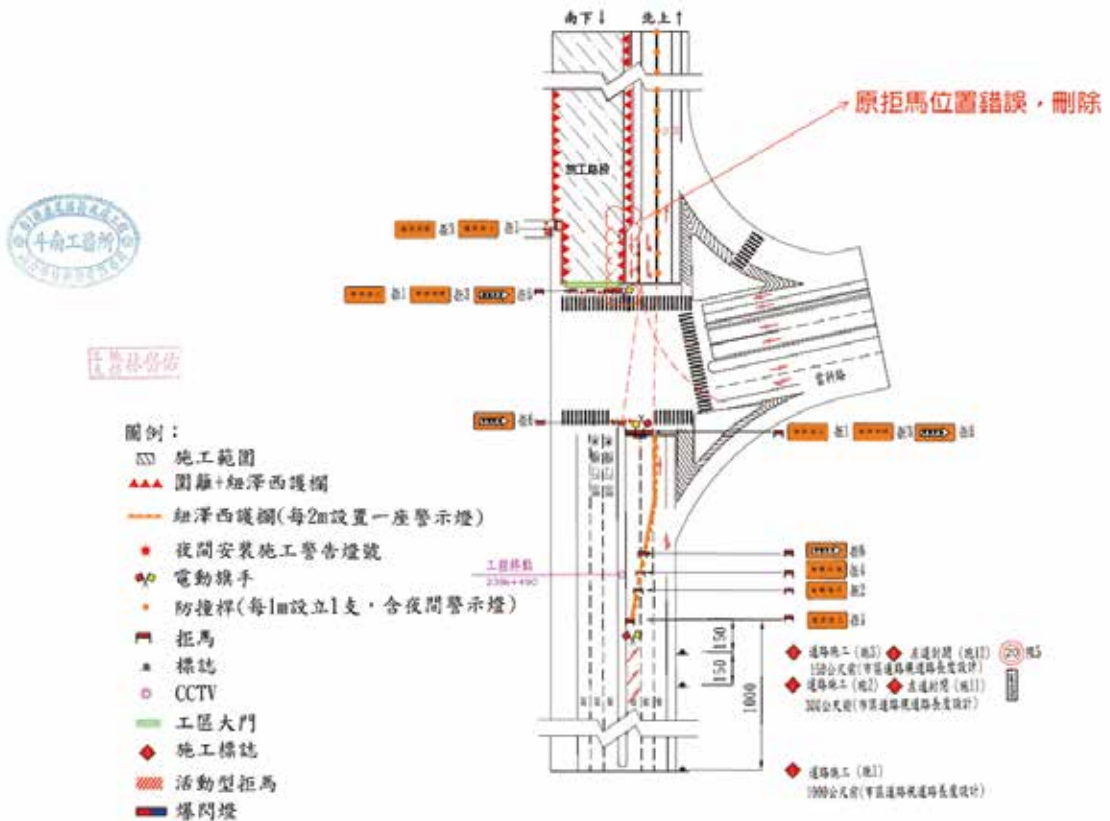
第二階段施工交維車行路徑平面圖示 (南端)
